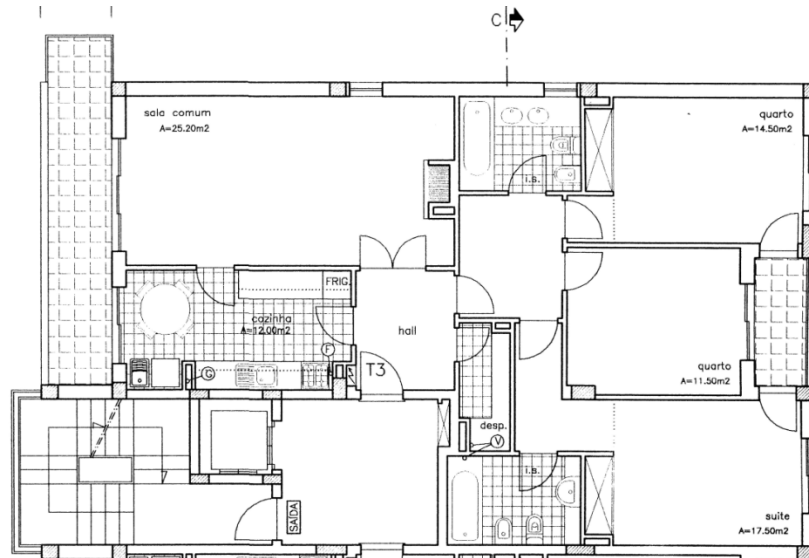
Planta da fração autónoma T₃ do 3º piso do Edifício Central 2.
